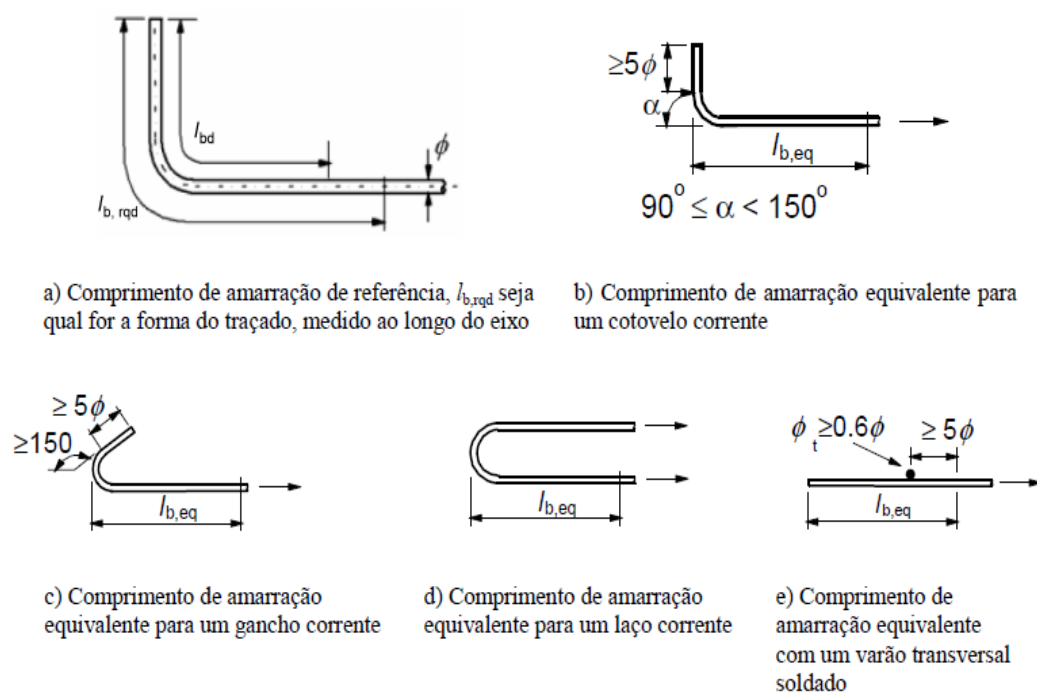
Tipos de amarração para além da de prolongamento reto (2).
